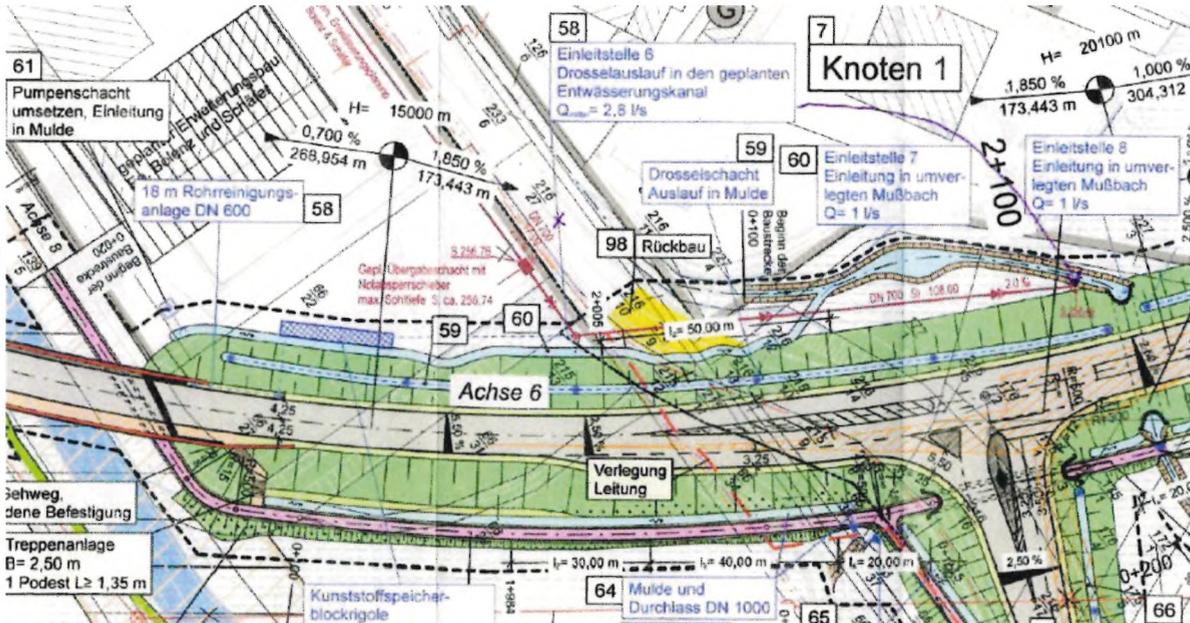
Planfeststellung mit Violetteintrag Einleitstelle 6 auf Lageplan 4
